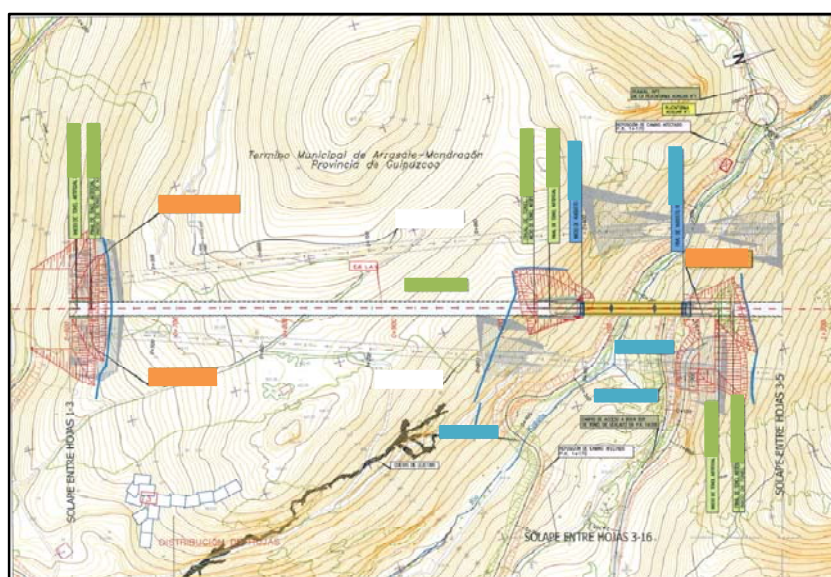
b-Perfil en planta del trazado (ver Anexo I)
